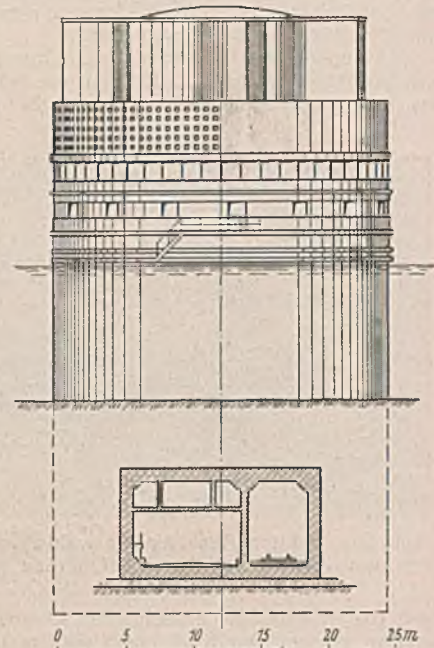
Querschnitt des Tunnels mit Lüftungsgebäude.
